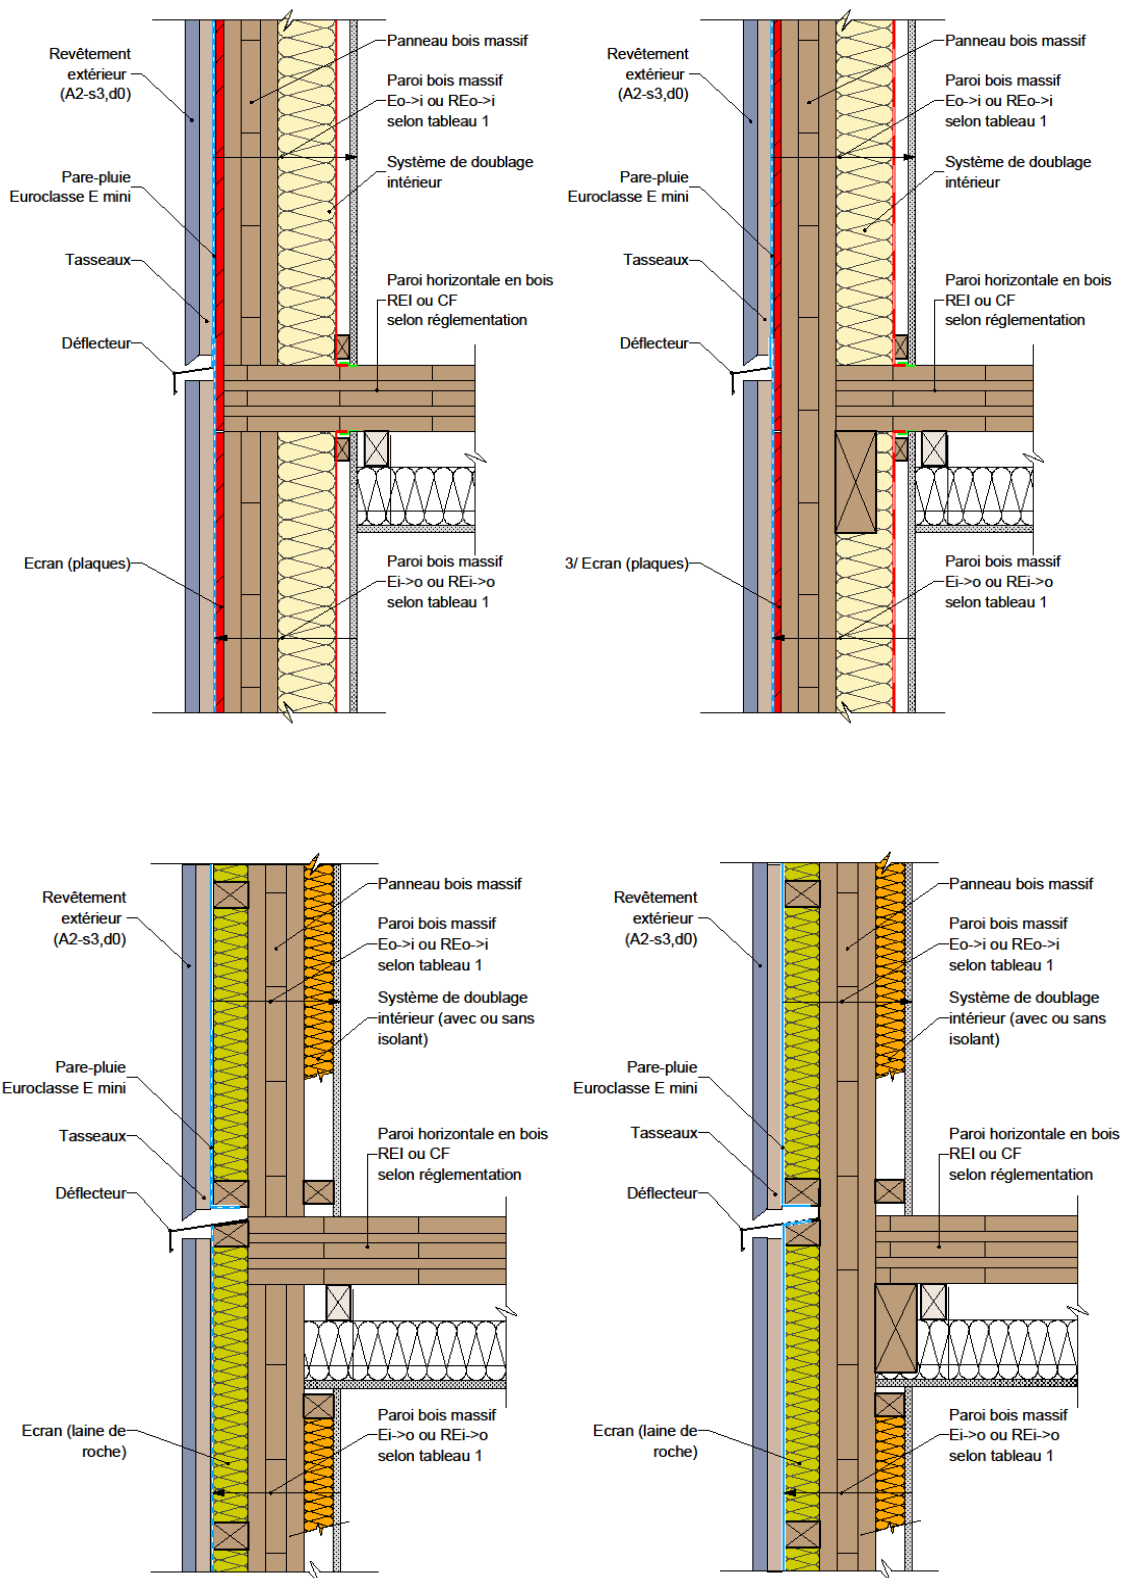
Façade/mur en panneaux bois massif & plancher en panneaux bois massif.
